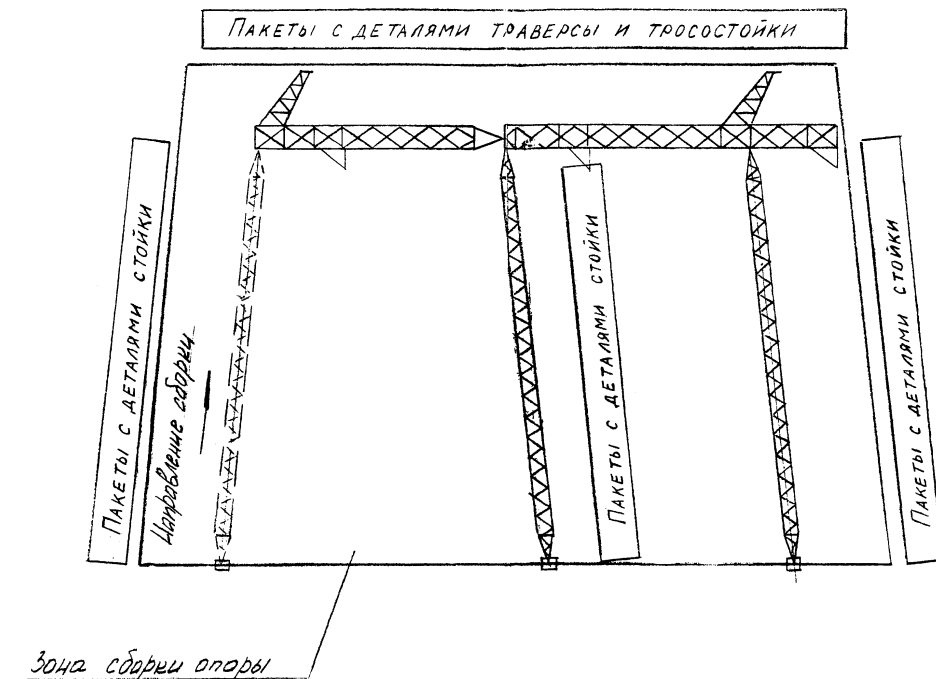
План площадки для сборки промежуточно-угловой опоры 1745-20
